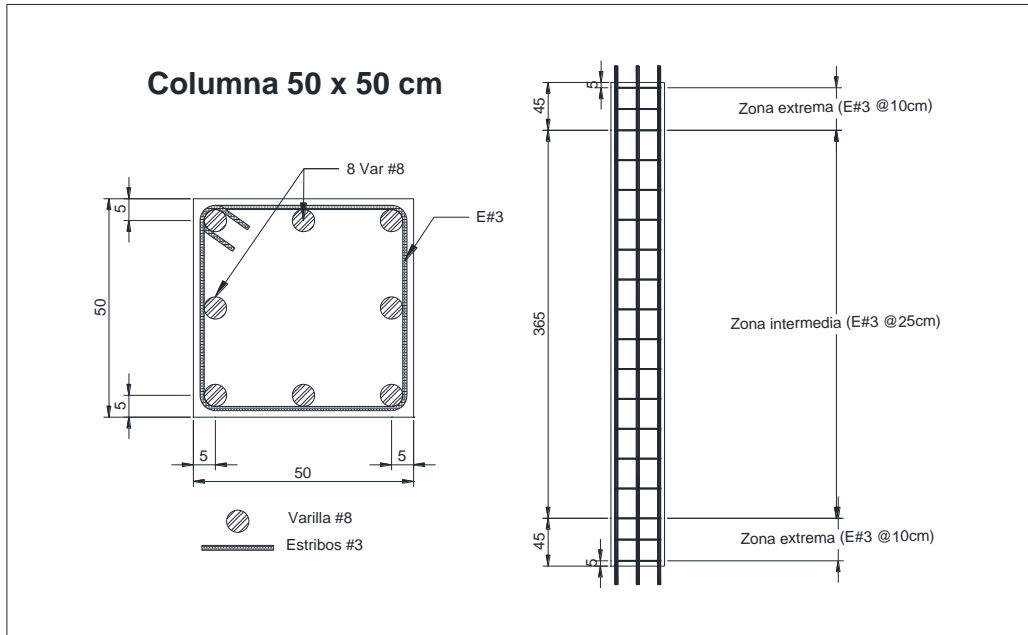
Armado tipo de columna con sección transversal de 50 x 50 cm.
